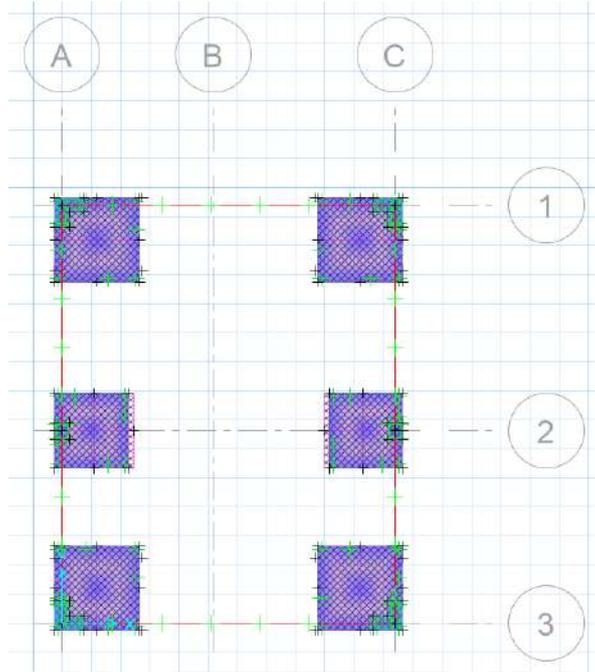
Franjas de diseño en la cimentación. Fuente: Propia.
